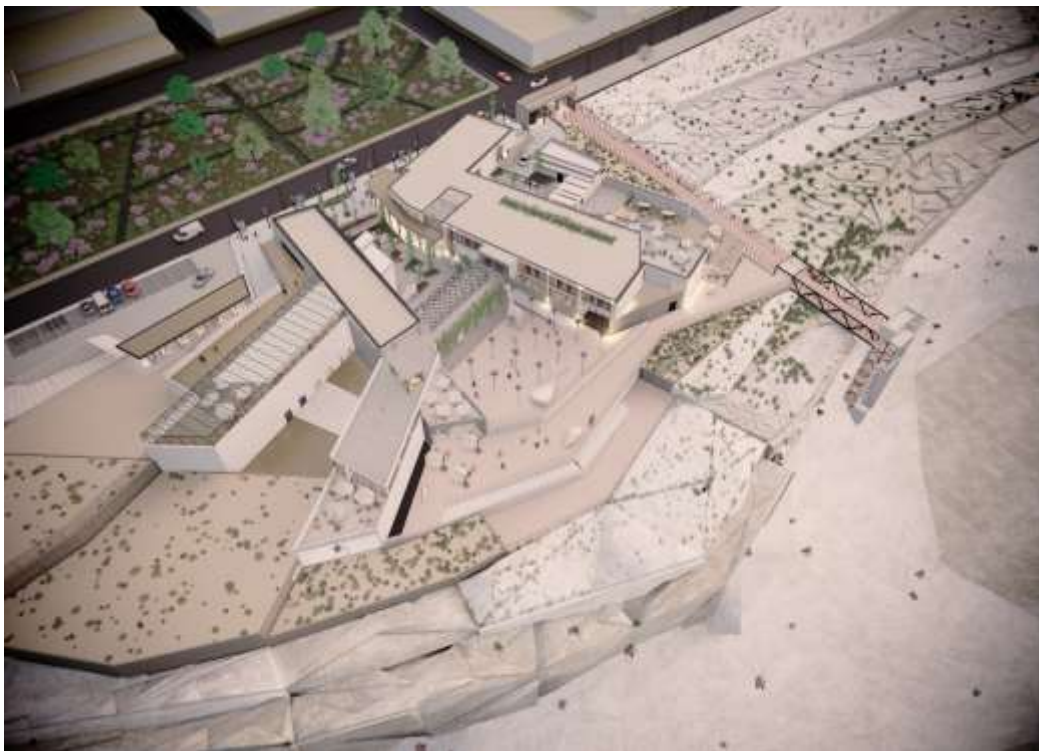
Perspectiva exterior de conjunto vista del ascensor hacia las canteras N°2.
